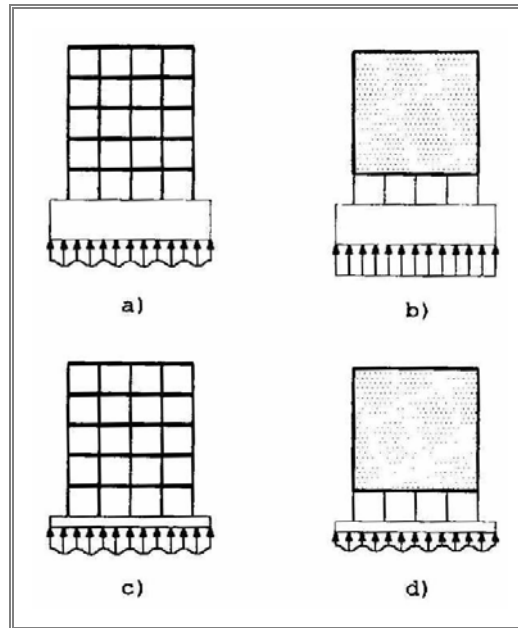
Esquema de funcionamiento de la cimentación: (a) losa rígida y estructura flexible, (b) tanto la losa como la estructura rígidas, (c) losa y estructura flexibles, (d) estructura rígida y losa flexible. (Calavera J. 2001) Cálculo de estructuras de cimentación.
